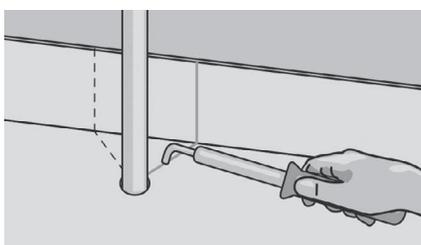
При укладке напольного покрытия вокруг труб рядом со стенами, надрежьте покрытие и прижмите его к трубе, чтобы сформировать «воротник». Если расстояние между трубой и стеной маленькое, сделайте надрез так, чтобы потом осталась возможность его беспрепятственно сварить. Т.е. качество сварки и последующая функциональность имеют приоритет над эстетическим внешним видом. Если нужно сделать обшивку, вам необходимо:
